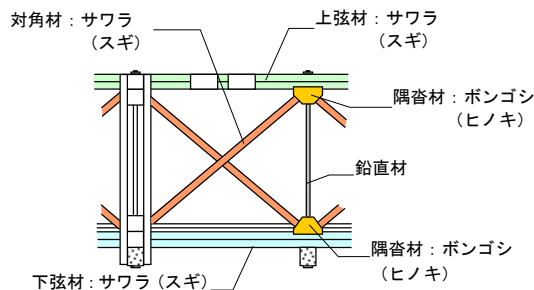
補剛桁側面図 (カッコ内は原設計時の使用材)
